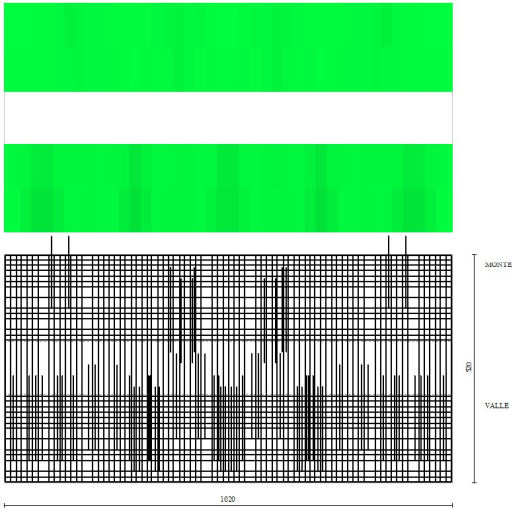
Piastra fondazione dir. X (Inviluppo)
